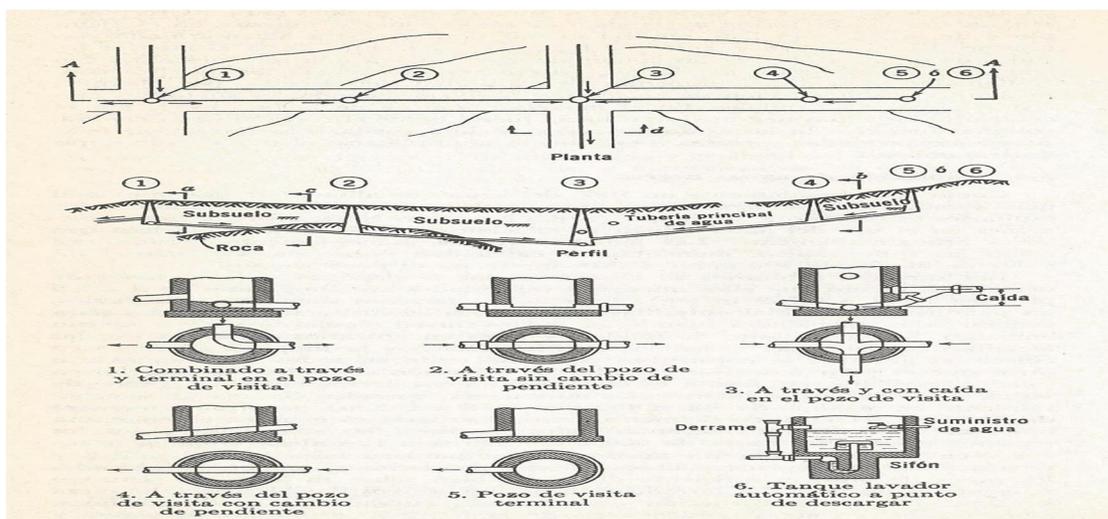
Planta, perfil y detalles de construcción de alcantarillados sanitarios
